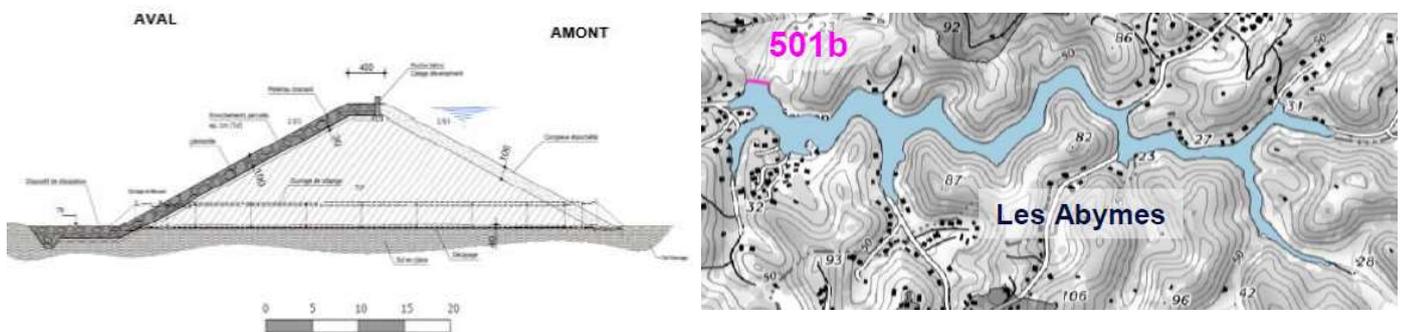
Coupe type ouvrage de Bozon (à gauche) et emprise du plan d'eau intermittent amont (à droite)
